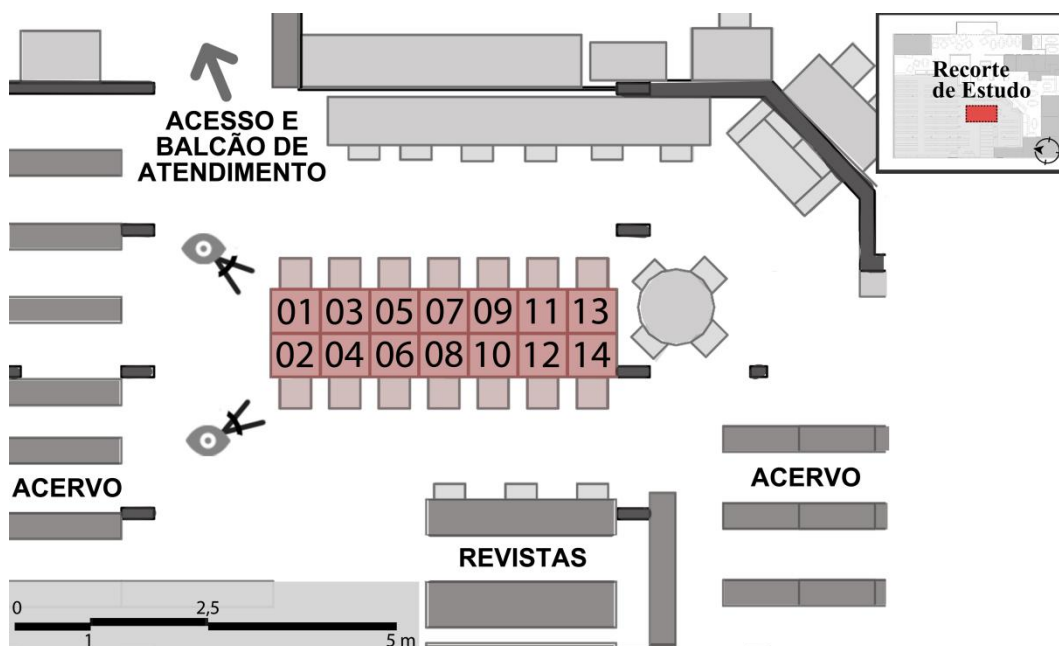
Planta de layout, atualizada da Biblioteca UNESP Bauru.
